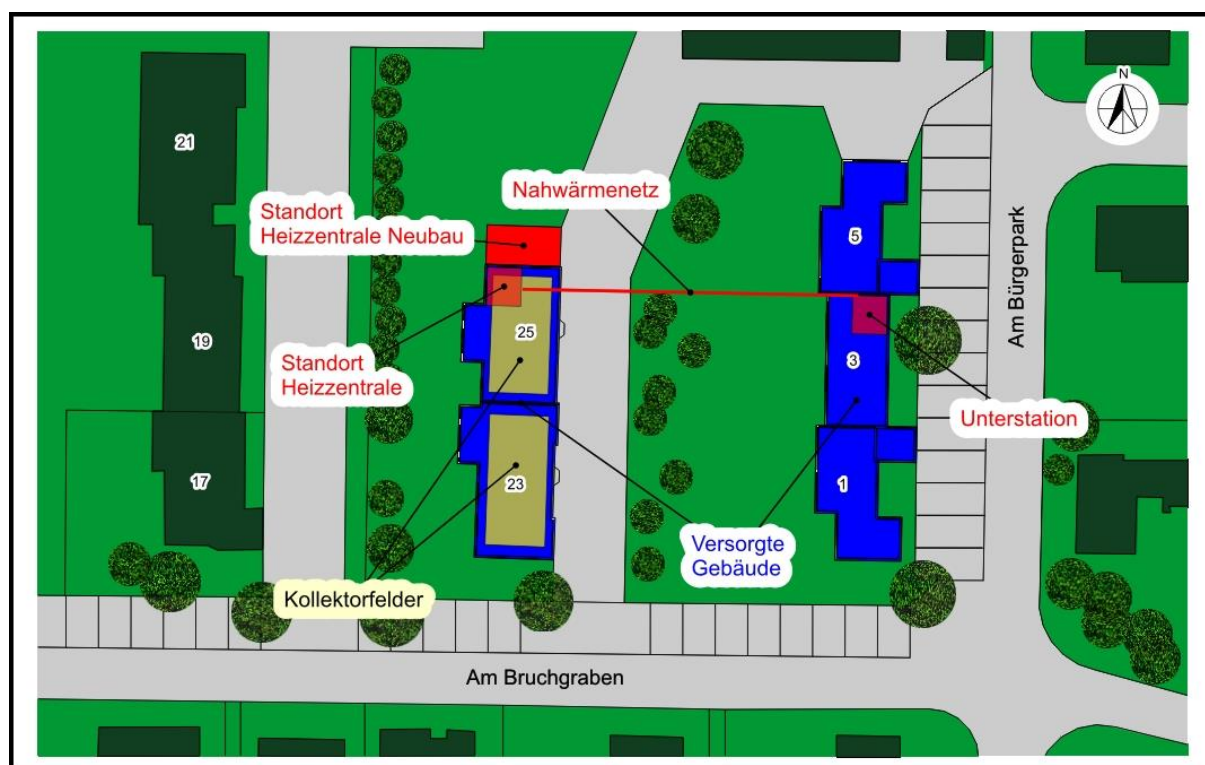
Lageplan Sarstedt, Wohngebiet Am Bürgerpark / Am Bruchgraben
